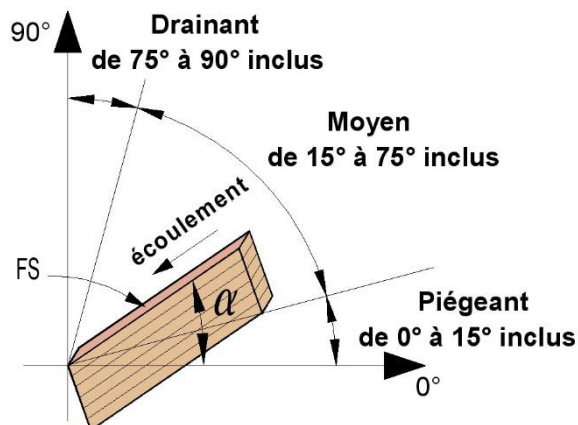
Ecoulement longitudinal sur la Face Supérieure
